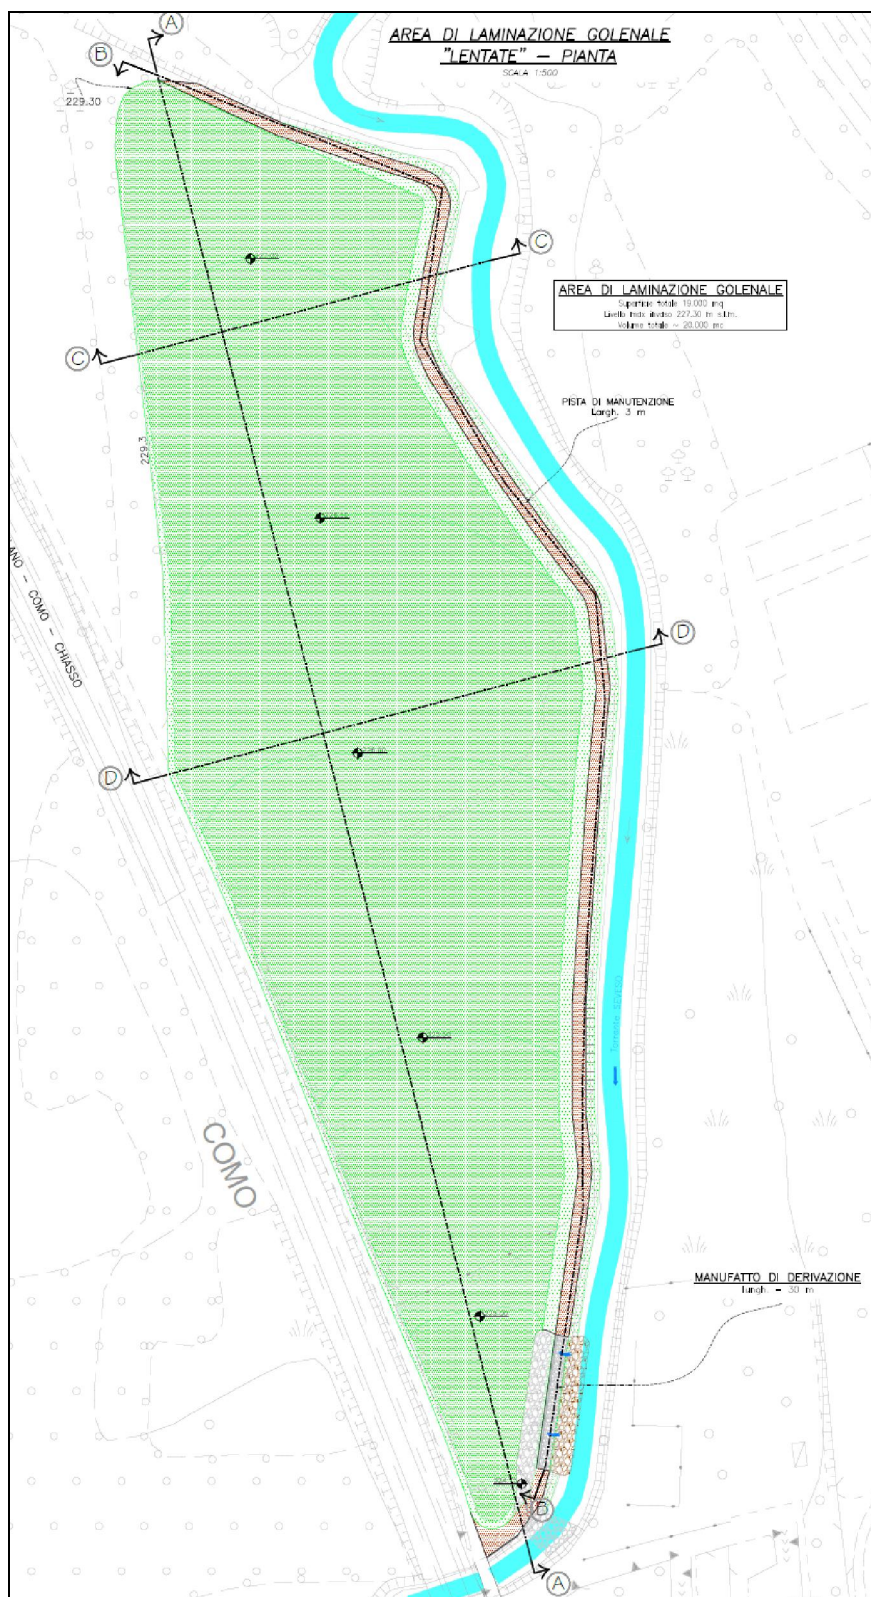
Schema planimetrico dell’area di laminazione golenale di Lentate sul Seveso
